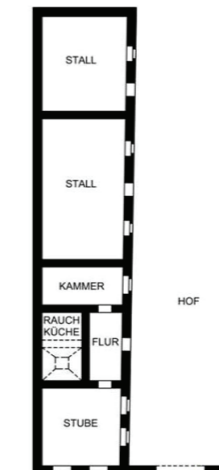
Grundriss eines abgeriegelten Mittelfurhauses
